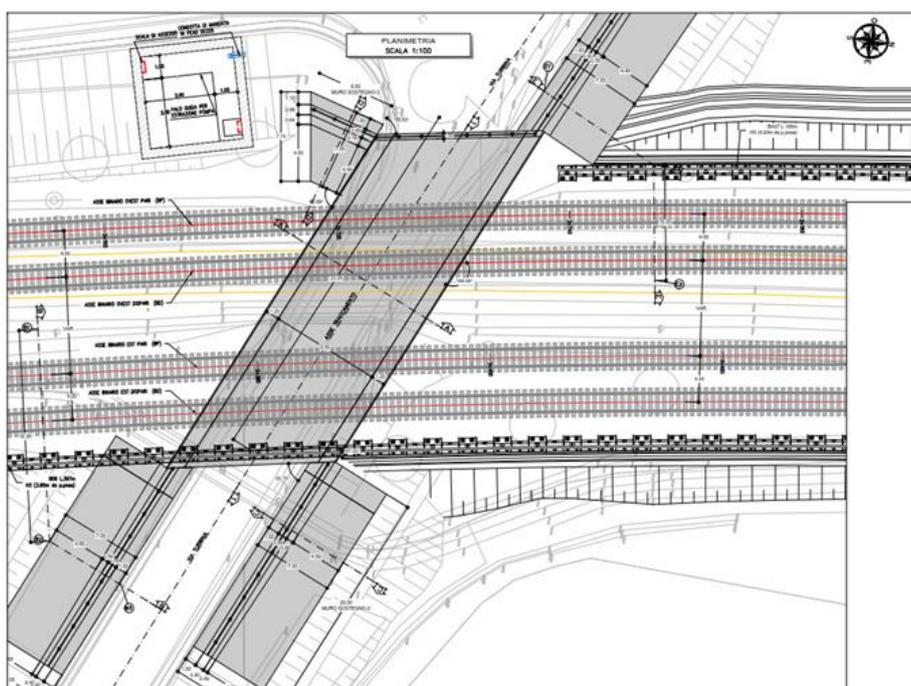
SL03 – Stralcio planimetrico sottovia via Turbina
